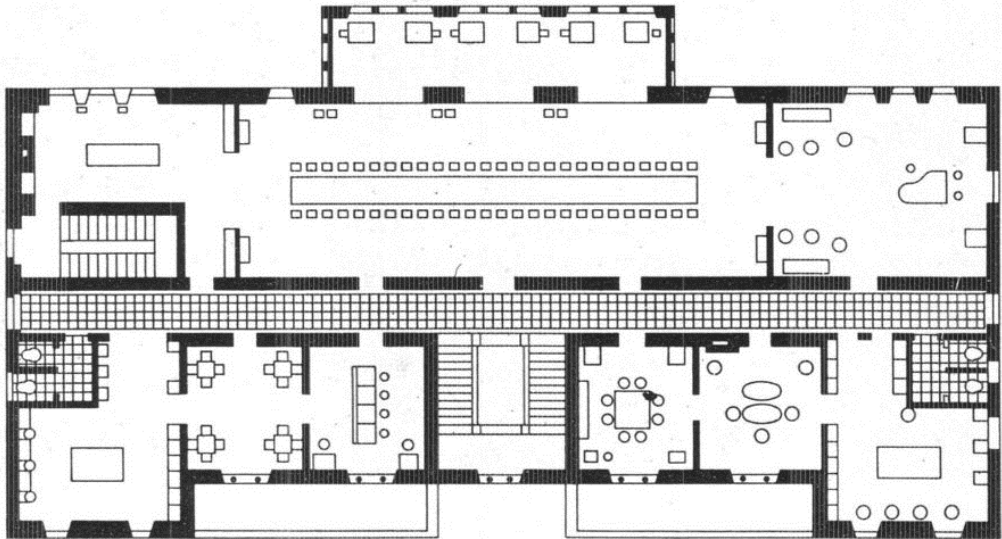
Grundriss des Sanatoriums am Beispiel des Erdgeschosses [27]
